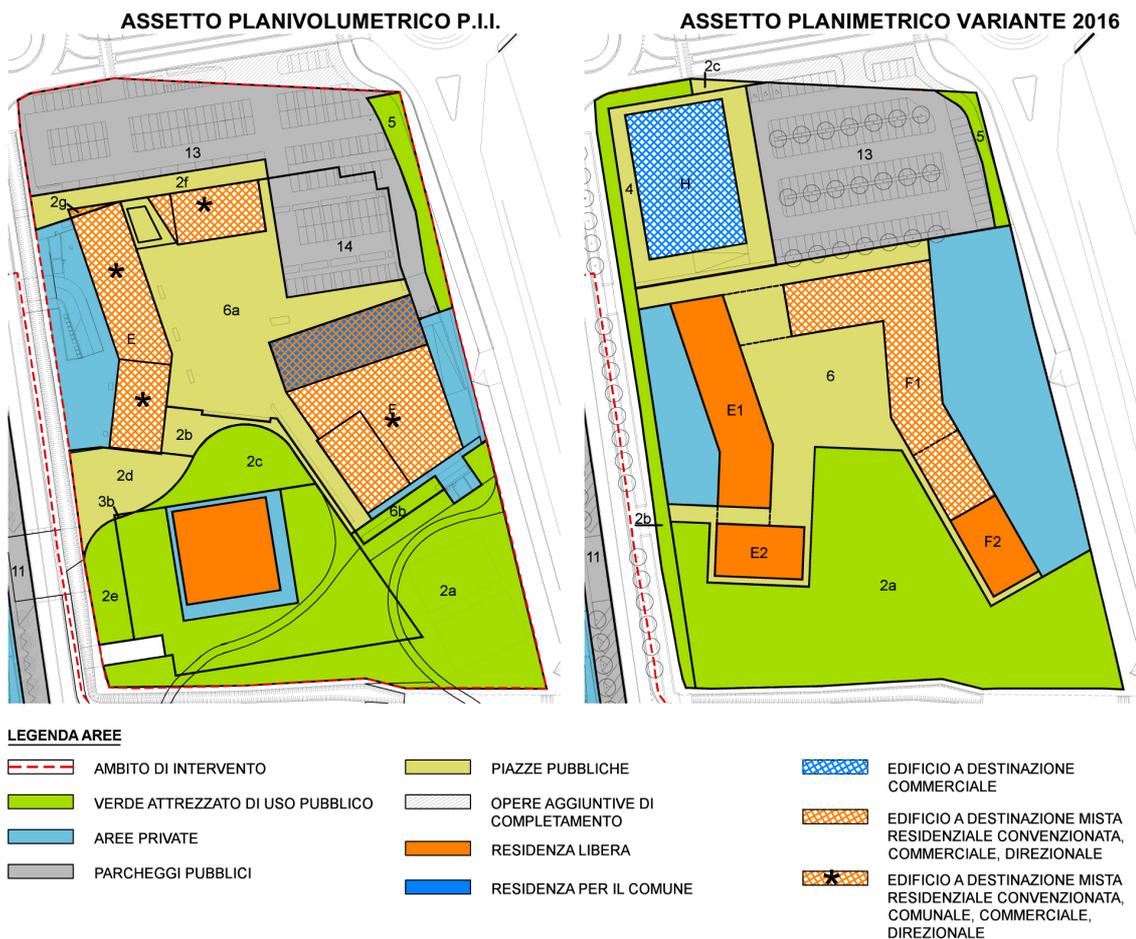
| Lotto 2: Confronto tra la planimetria di P.I.I. e variante 2016.
